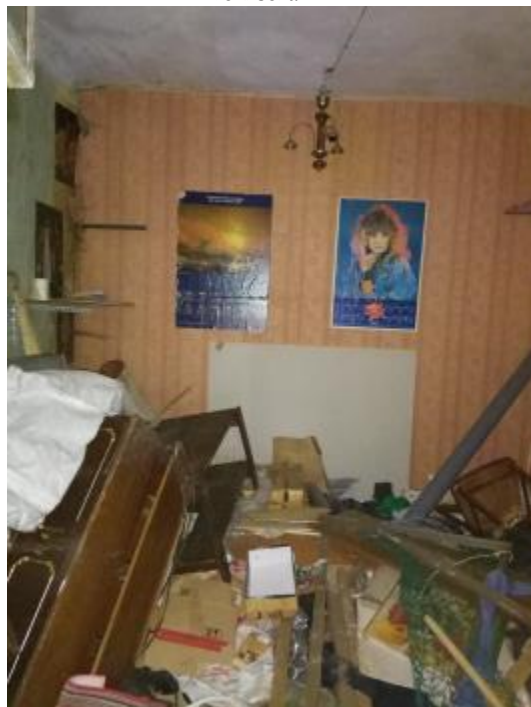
Кладовая (ч.п. № 1), заложен оконный проем
